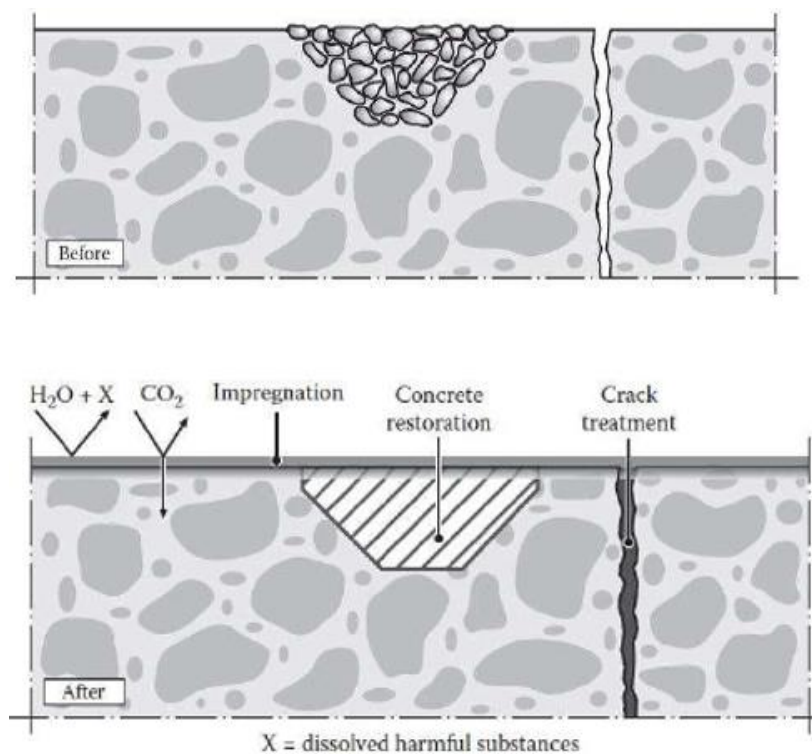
Exemplificação de danos e possível reparação num elemento de betão (Raupach e Buttner 2014)
